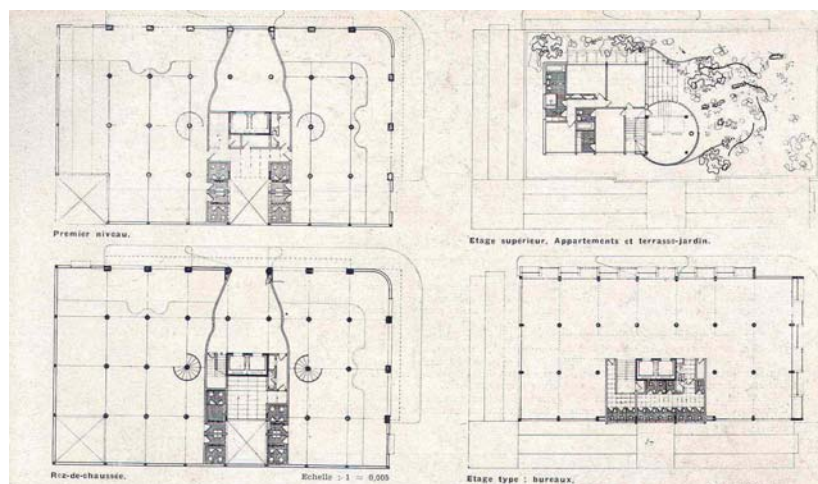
Edifício Caramuru – planta do térreo, pavimento-tipo e cobertura⁵
